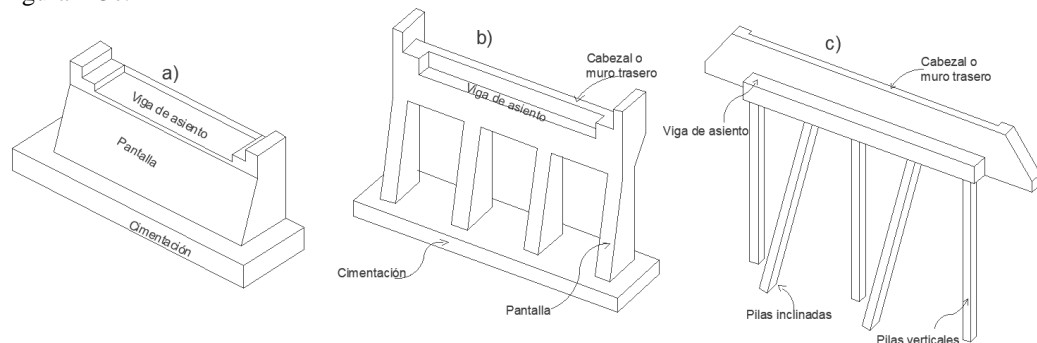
3 a) Estribo de pantalla sólida, b) Estribo de pantalla hueca, c) Estribo de pilas
